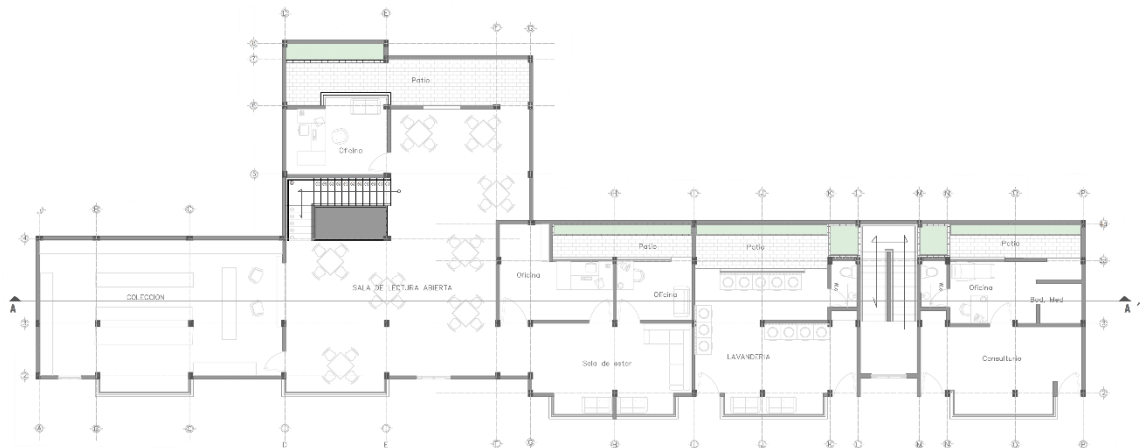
Primera planta, Bloque (A) propuesta arquitectónica dentro del centro de manzana.
